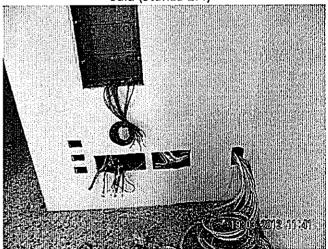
Stanza 1.1- Vista impianti elettrici cabalati
